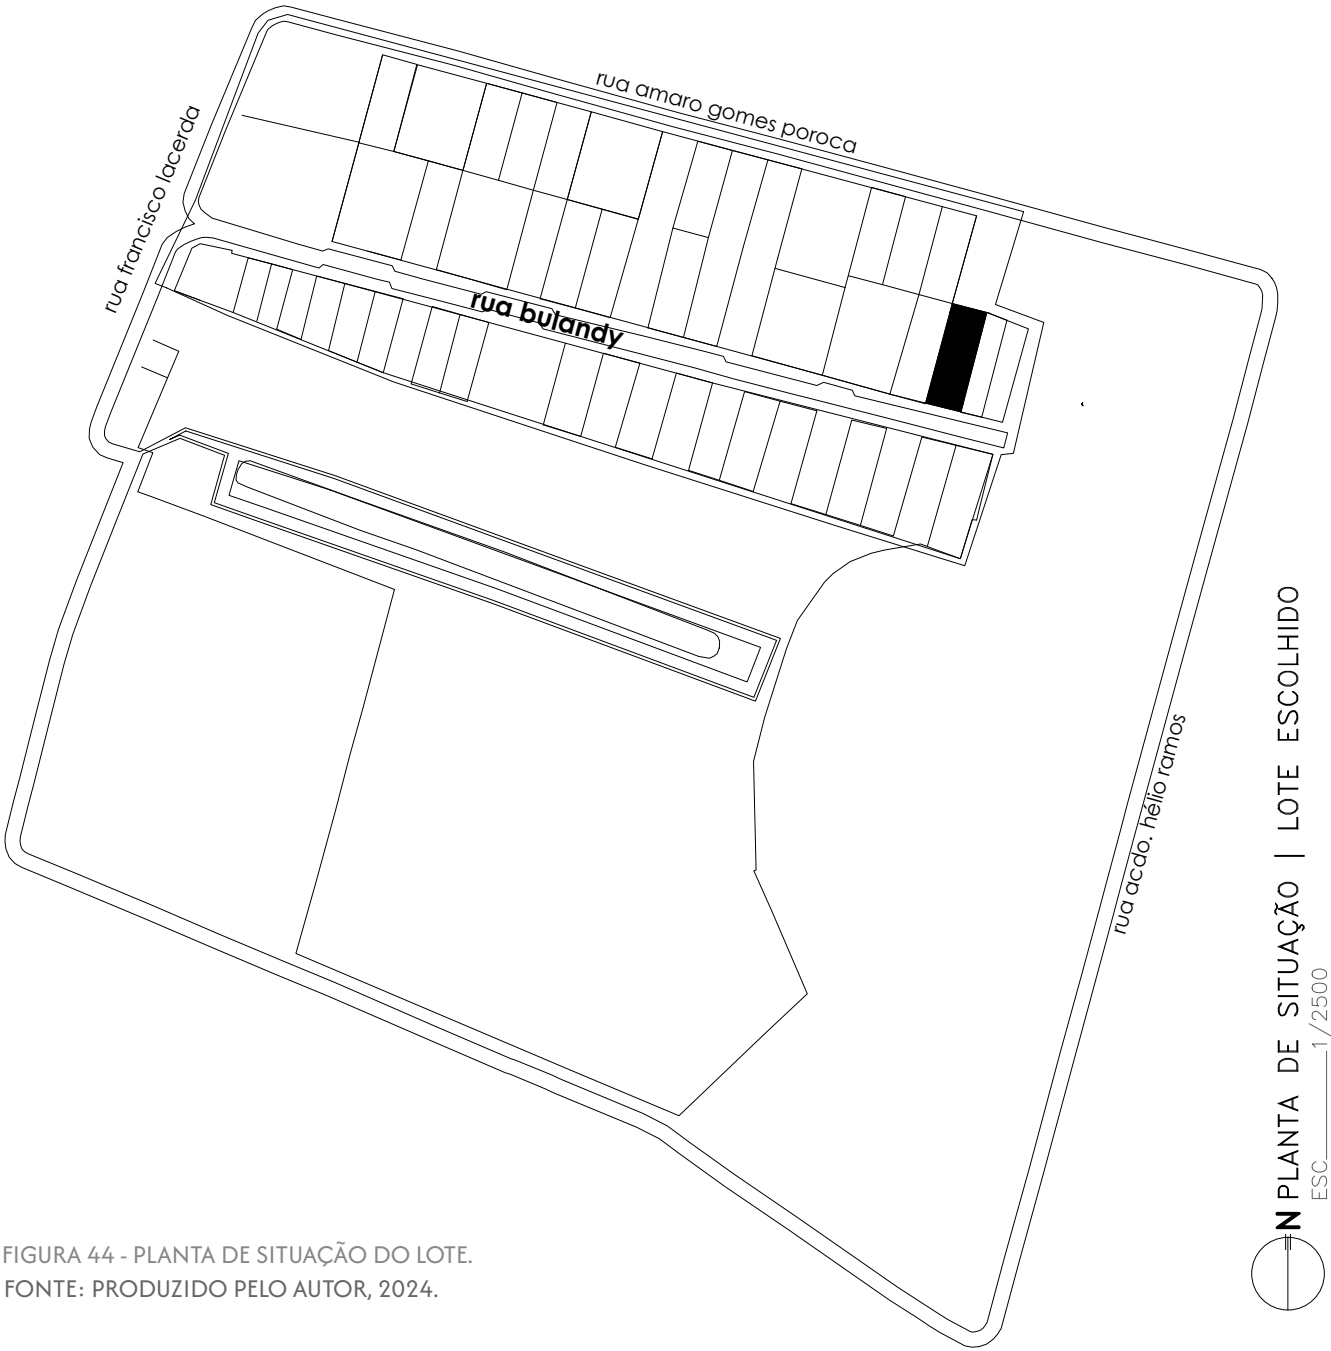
PLANTA DE SITUAÇÃO DO LOTE.
